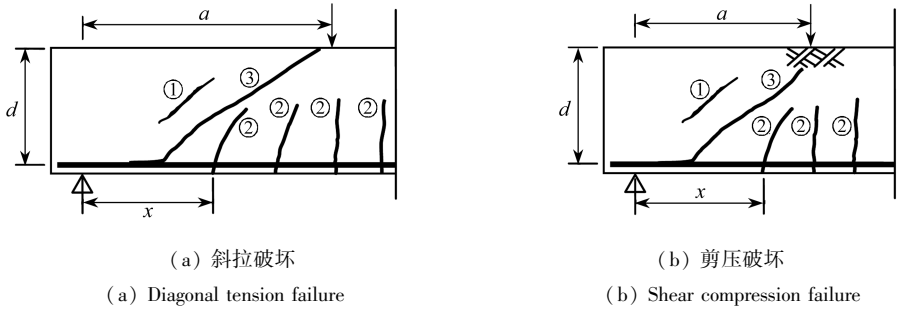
钢筋混凝土梁剪切破坏形态及3种裂缝类型
